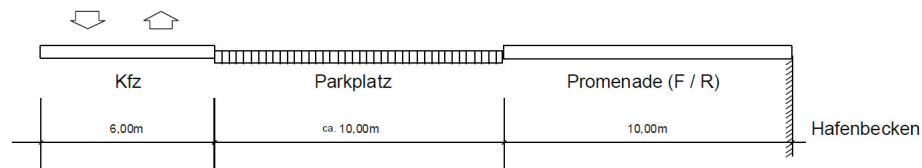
Querschnitt Planstraße A - Parkplätze - Promenade
